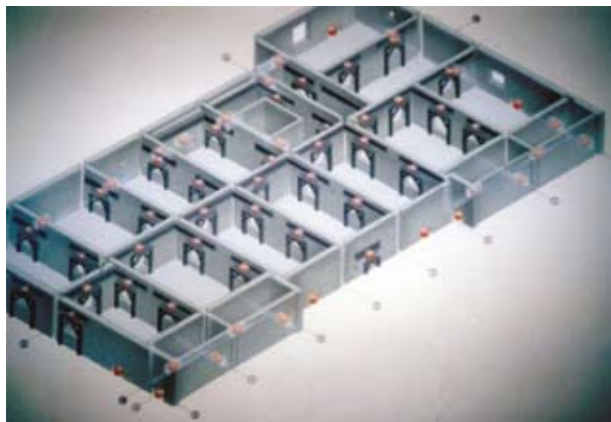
Регулируемые фундаменты с опорными столиками и разгрузочными балками в технологических проемах
